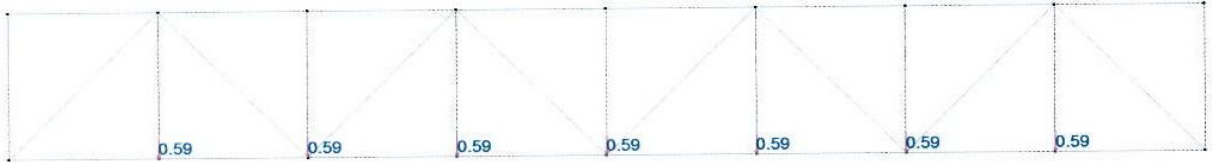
Полезная нагрузка на нижний пояс фермы
